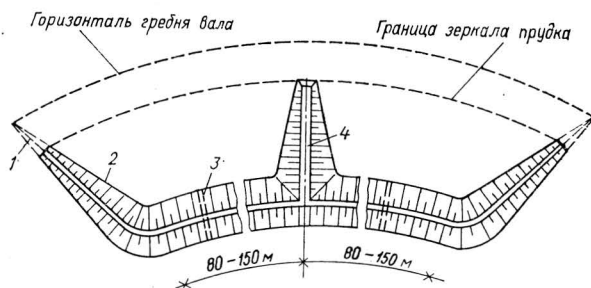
Общий вид водозадерживающего сооружения на склоне (вал-канавы в плане):
